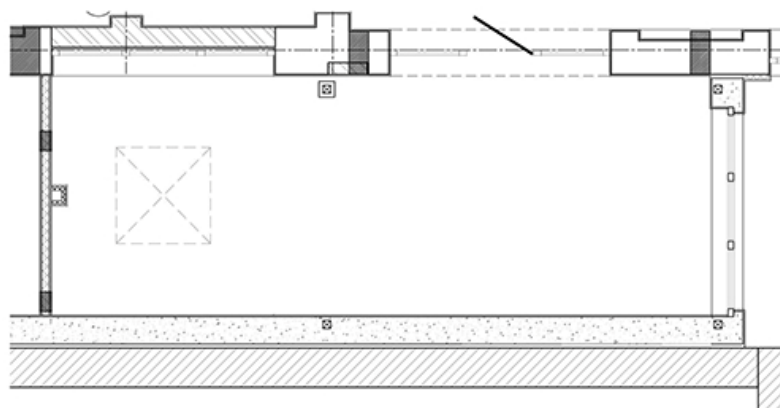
План помещения с квадратной формой фонаря верхнего освещения
